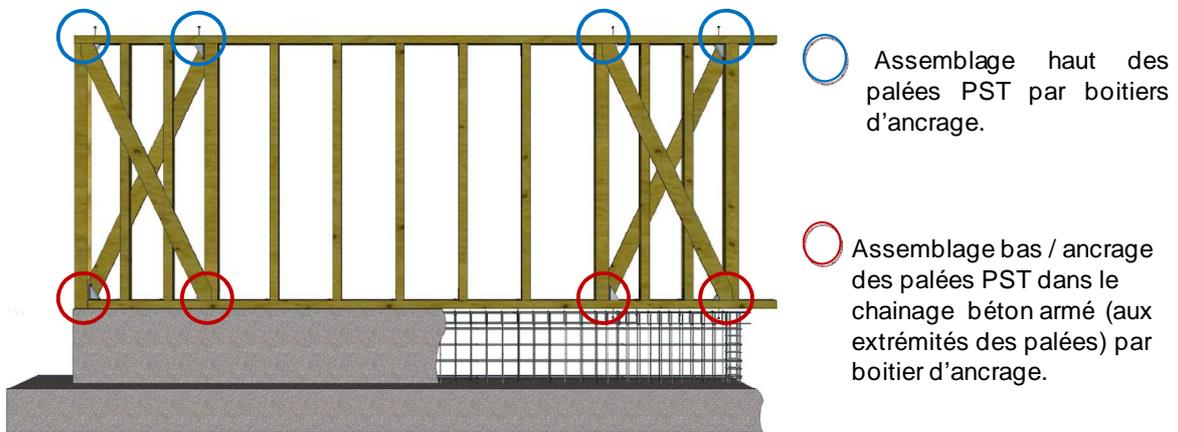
Représentation schématique d'un mur de façade avec palées PST1 sur libage de fondations.
